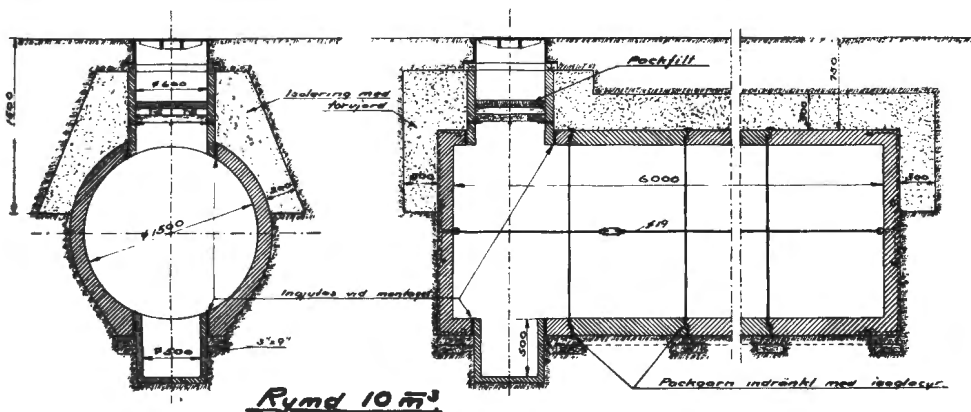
Mindre branddamm av kulvertrör (system: Sandviken).
